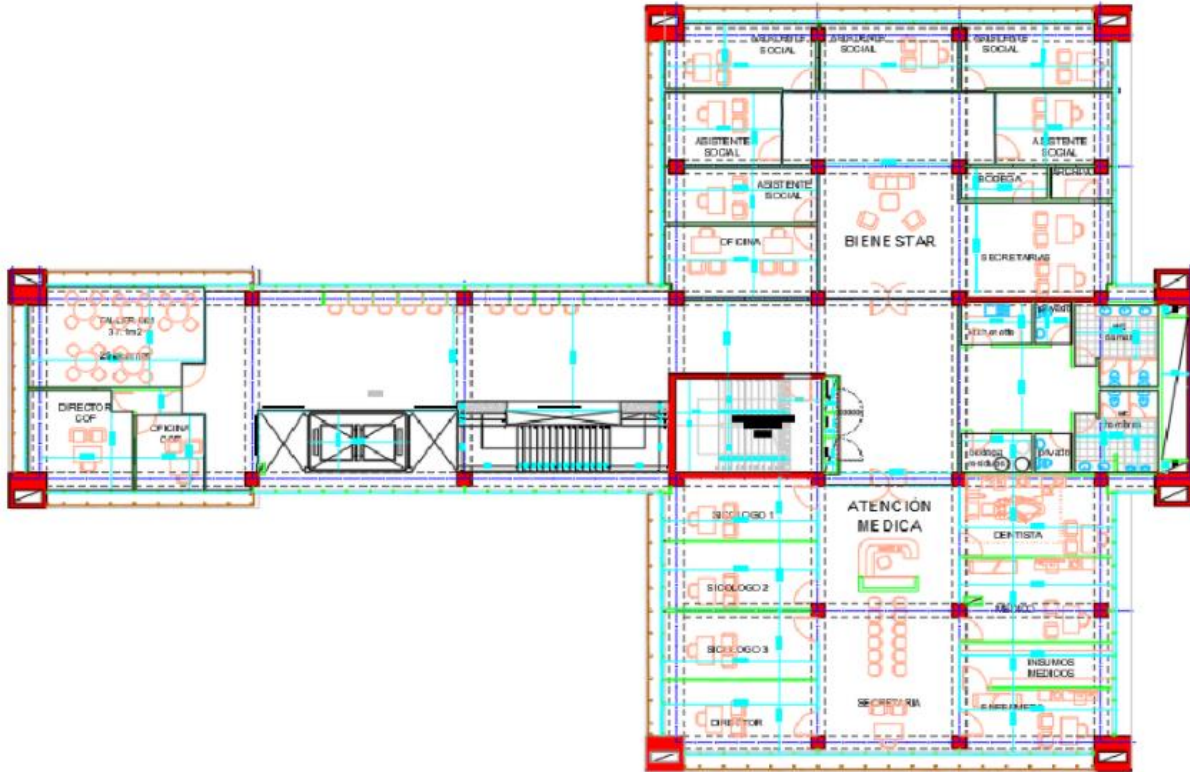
Planta arquitectónica sexto nivel Edificio Central.
